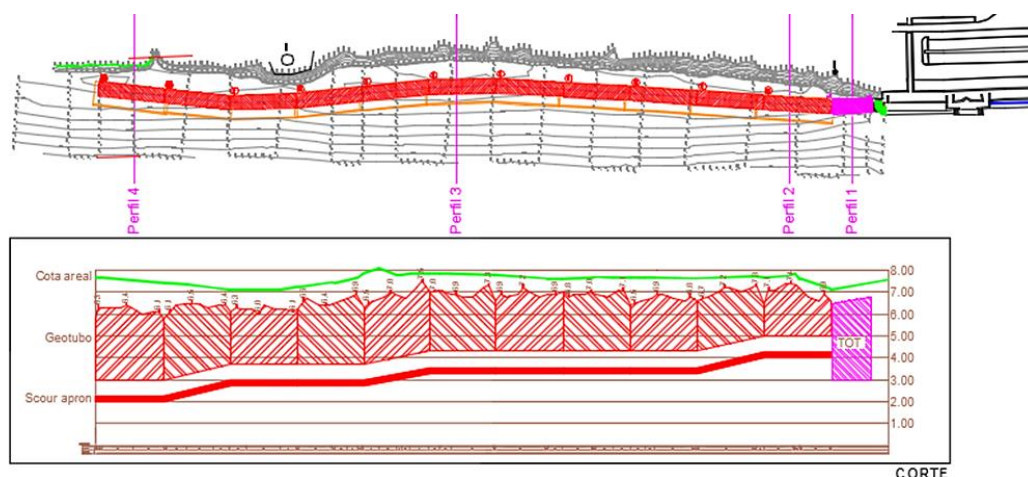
Implantação da estrutura ao longo da base da arriba da duna erodida. Levantamento feito após execução do projeto (MCA - M.Couto Alves, SA. Construções).
